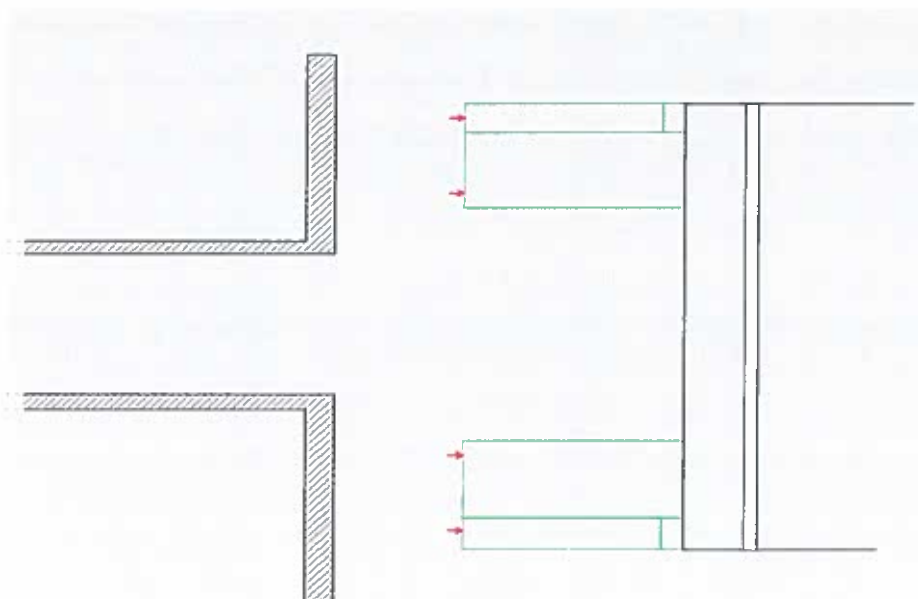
Esquema da planta do muro de reacção [elaborado pela autora]
